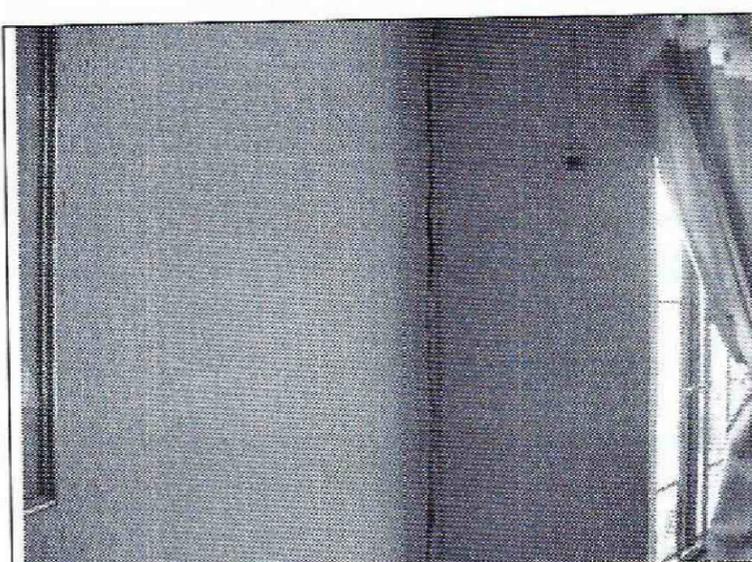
Detalle de las grietas en los muros de cerramiento de los espacios interiores.
